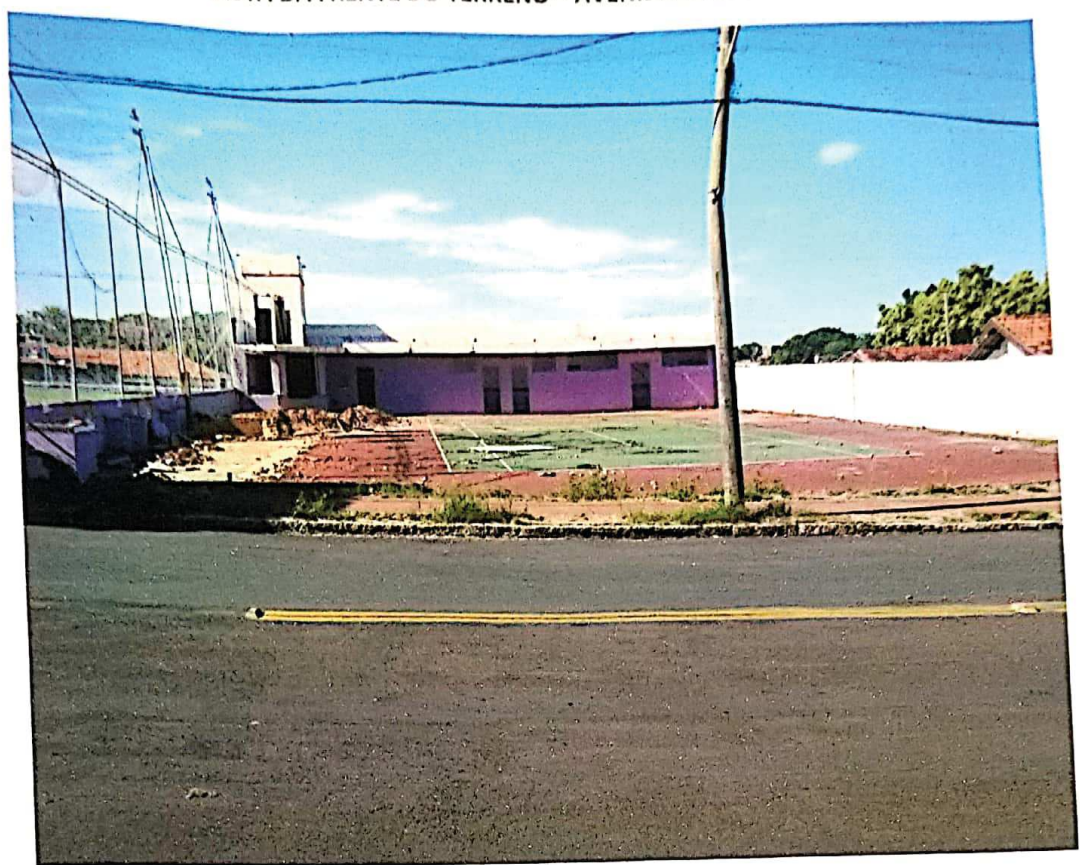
VISTA PARCIAL FRENTE AVENIDA FAUSTINA- LOTE 09 e 10
